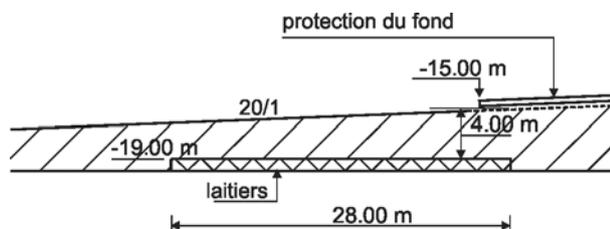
Couche de laitiers phosphoriques placée aux pieds aval et amont du seuil avant la construction
